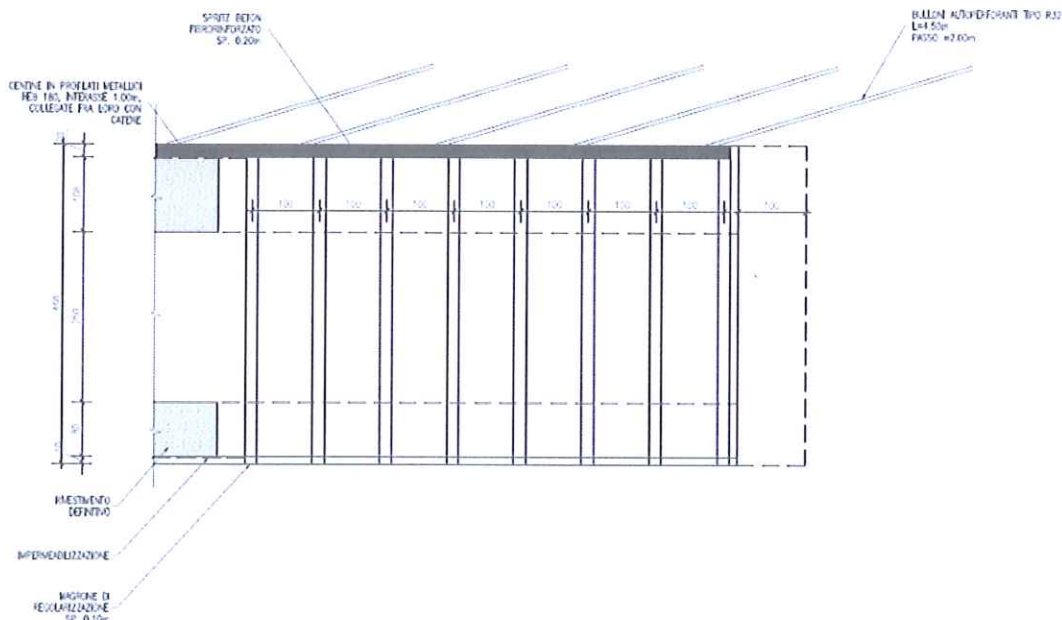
Consolidare temporară pentru *tunelul orizontal
